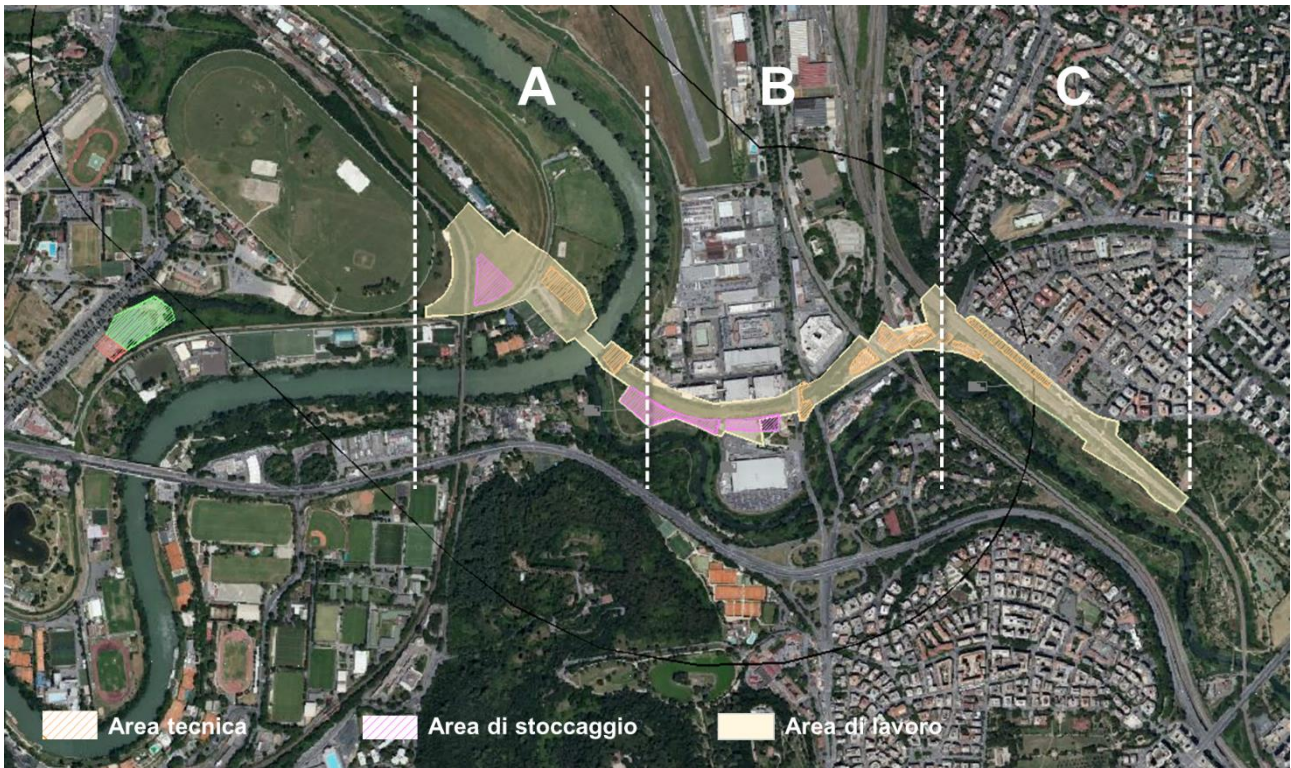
Aree di lavoro ed aree di cantiere fisso: Contesto localizzativo
